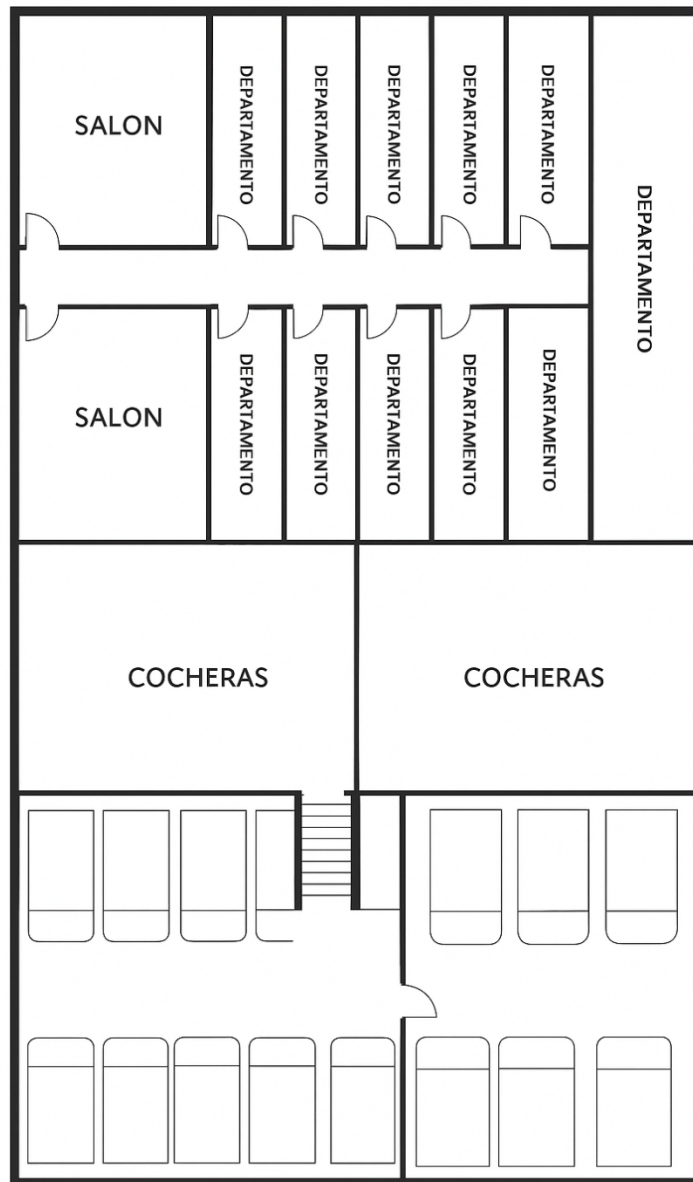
Plano de obra civil potencial. Modificado (2025) en funcion de planos de obra civiles anteriores.
